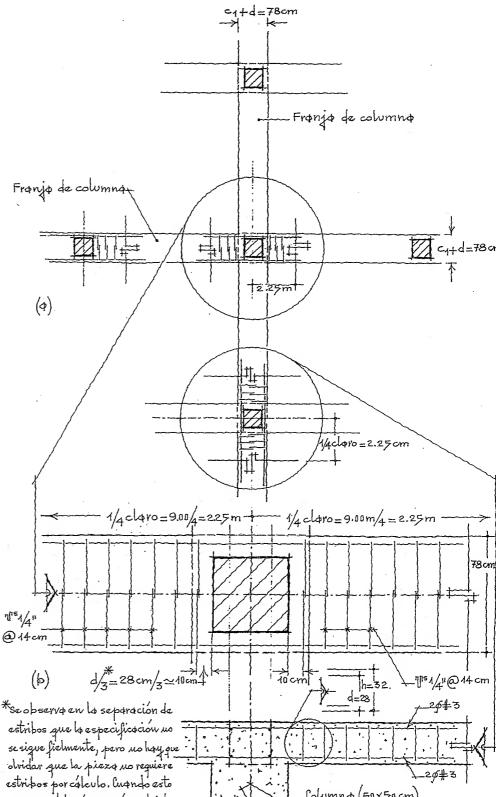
Fronjo efectwo de columna visto enplanto, (b).
